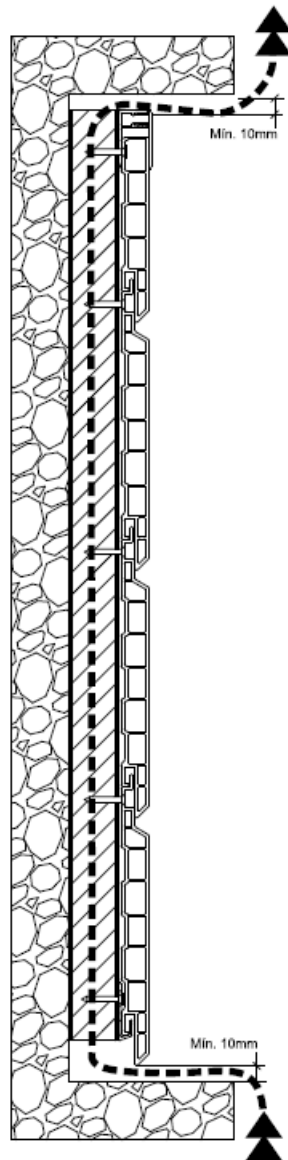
Vista lateral del esquema de una fachada SAGIWALL
